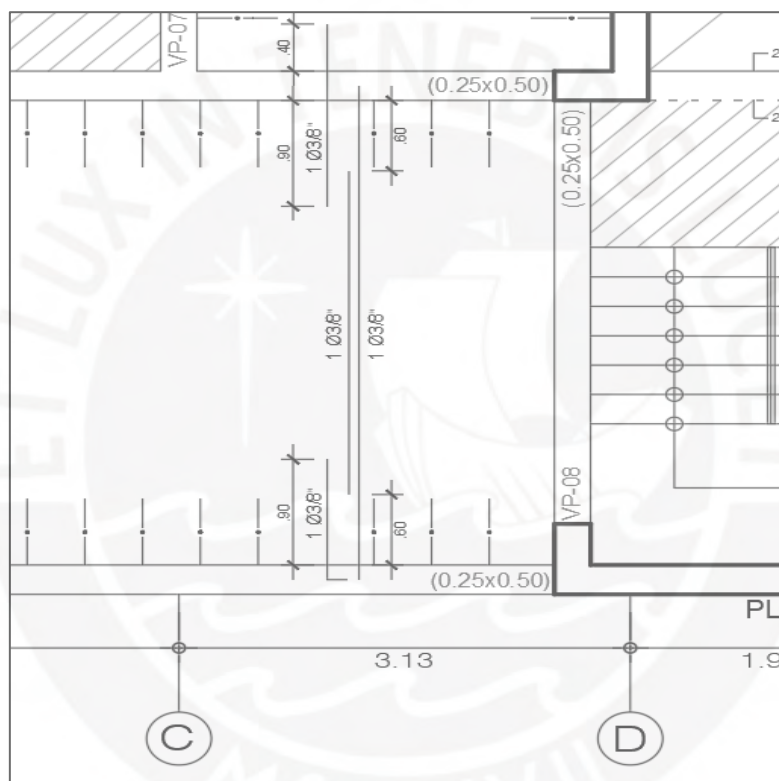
Esquema final del refuerzo colocado en la losa aligerada analizada
